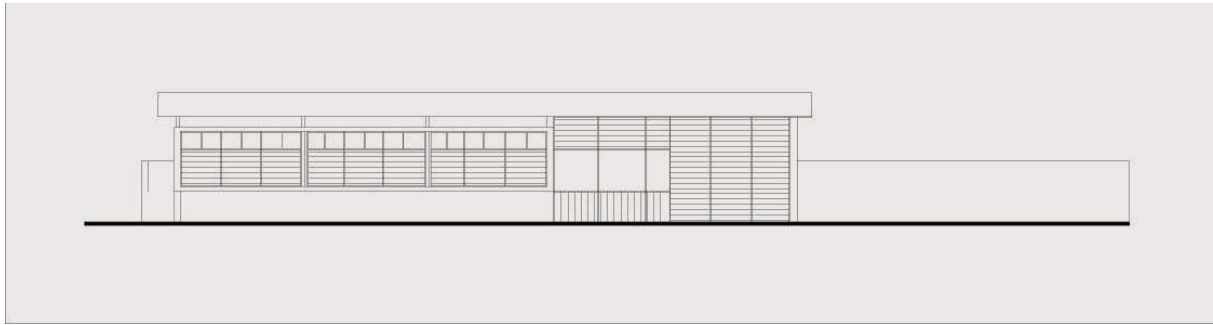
Fachada Leste da casa Tubal Valença. 1969.
